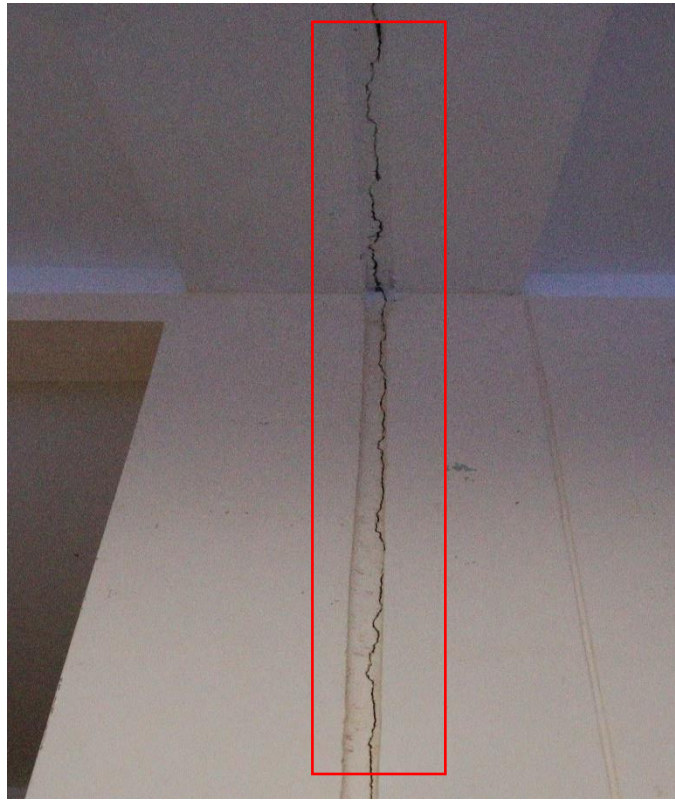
Fisuración muro eje A primer nivel
